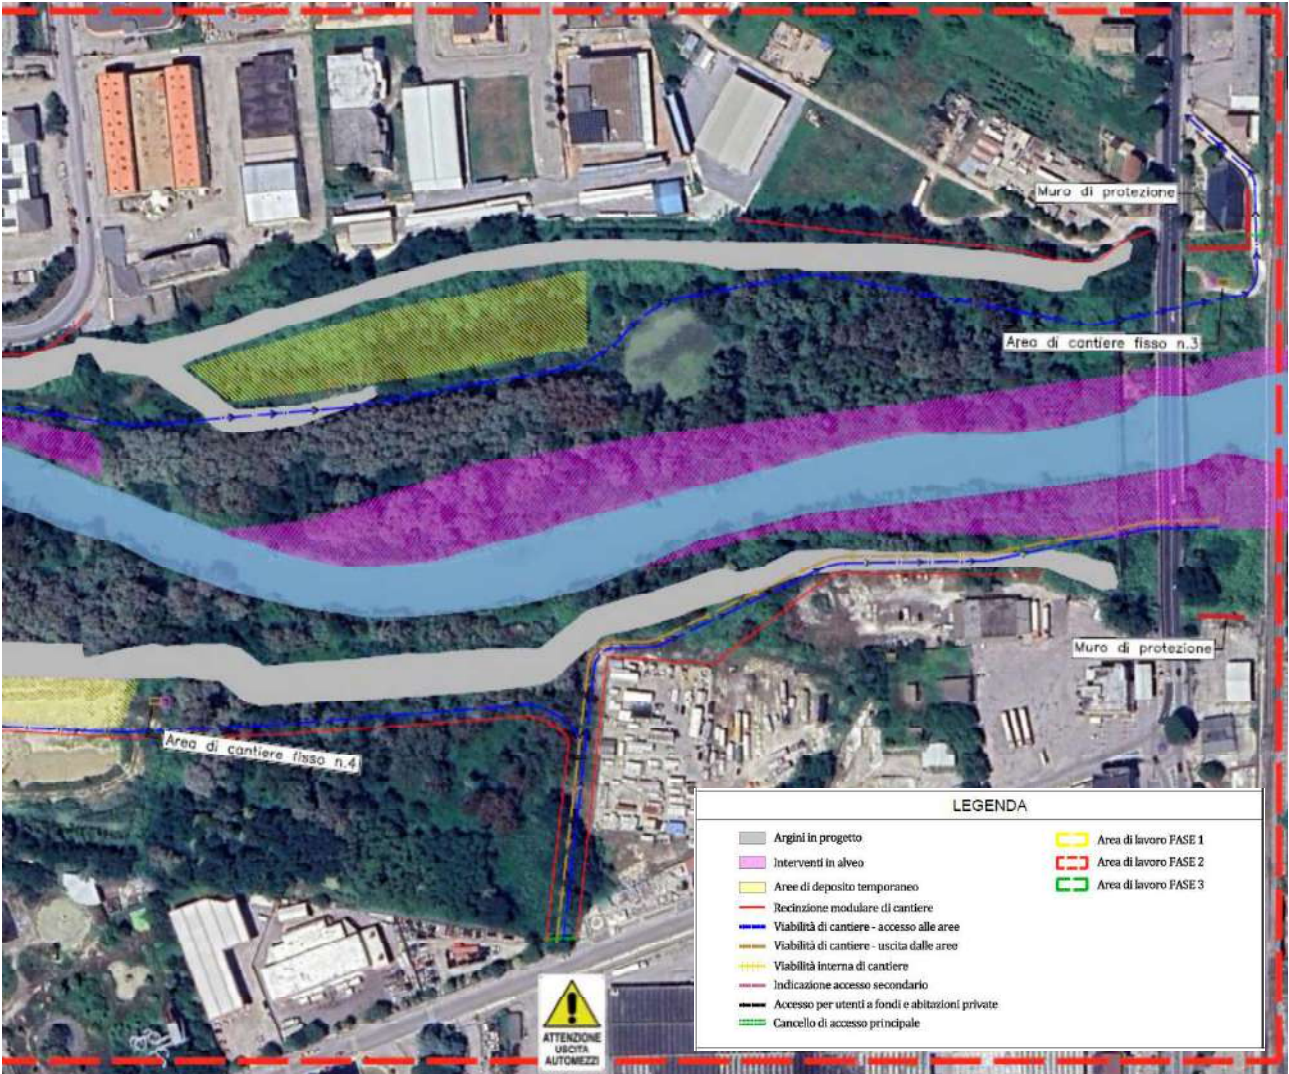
Cantierizzazione - Fase 2 (tratto di valle)
